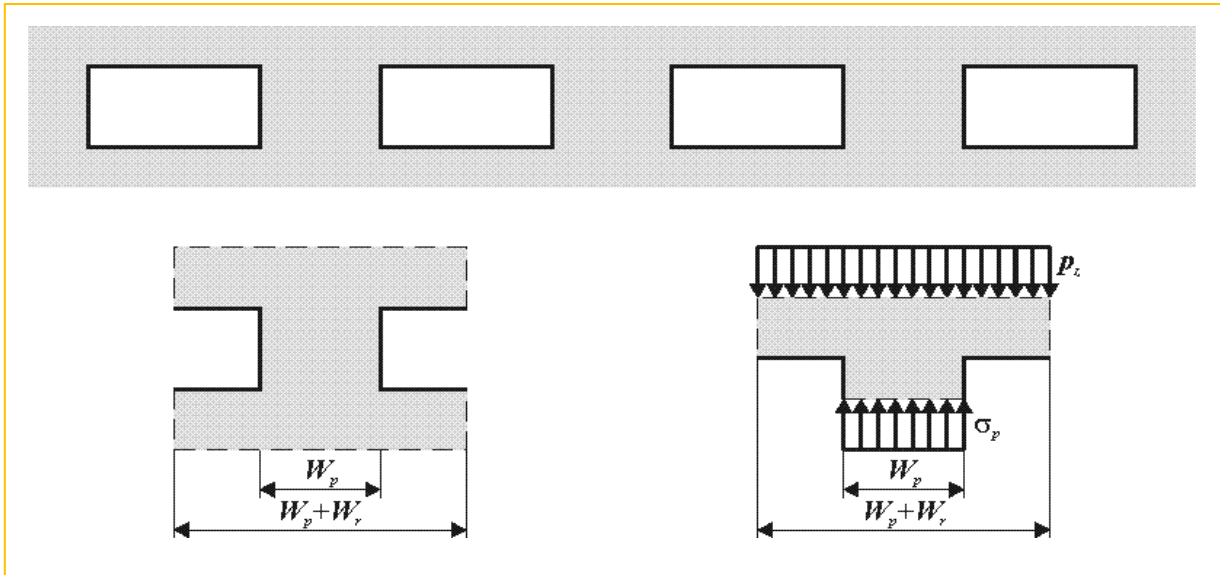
Coupe transversale d' une couche positionnée horizontalement, (Brad. BHG, 1985)
